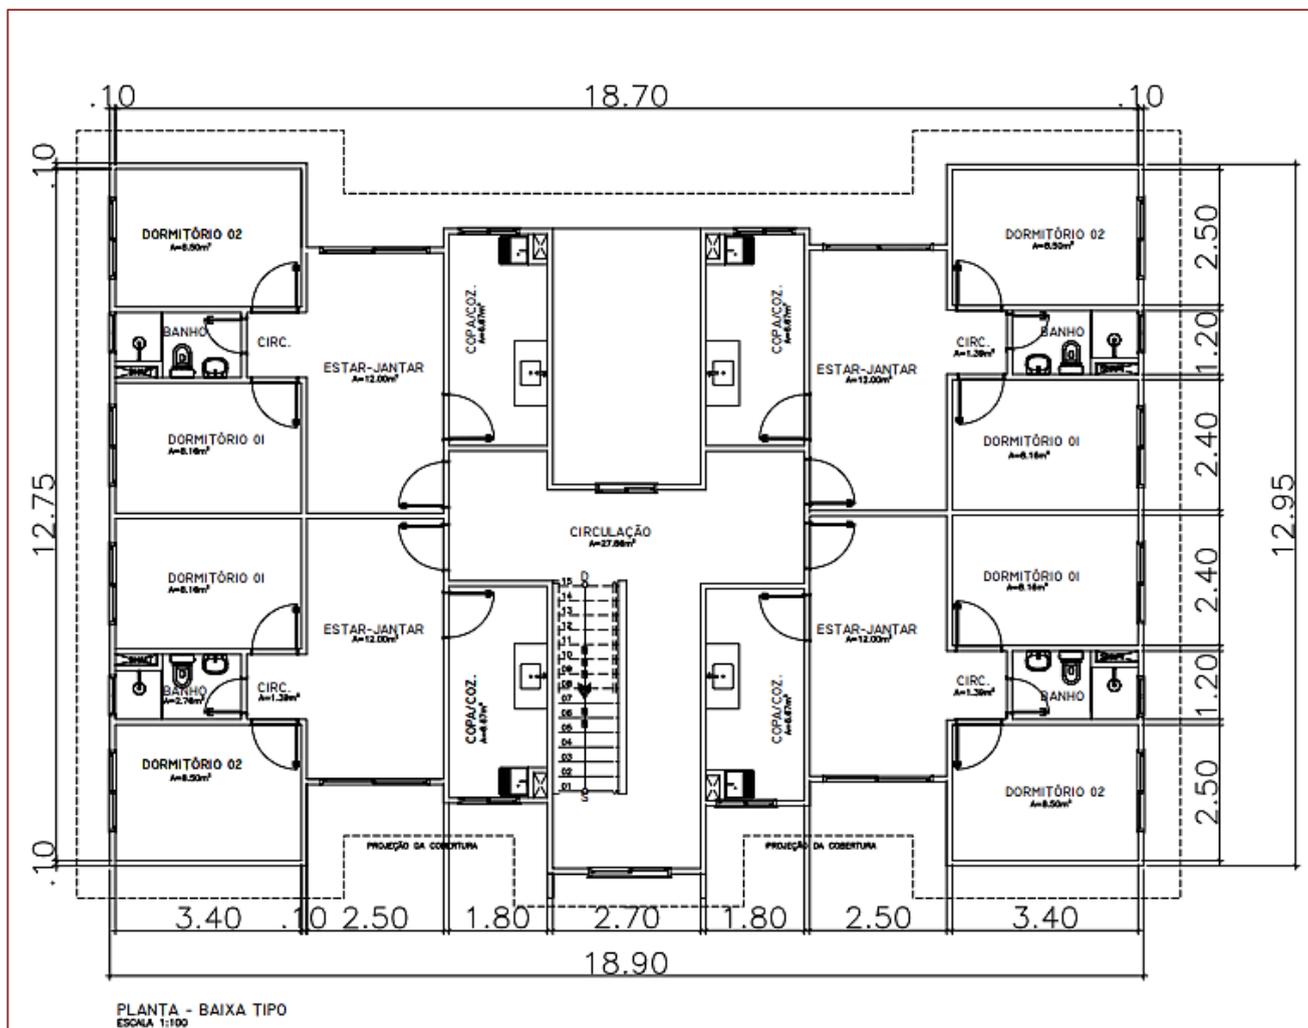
Planta baixa original (Residencial Manuara 3 – Manaus – AM).
